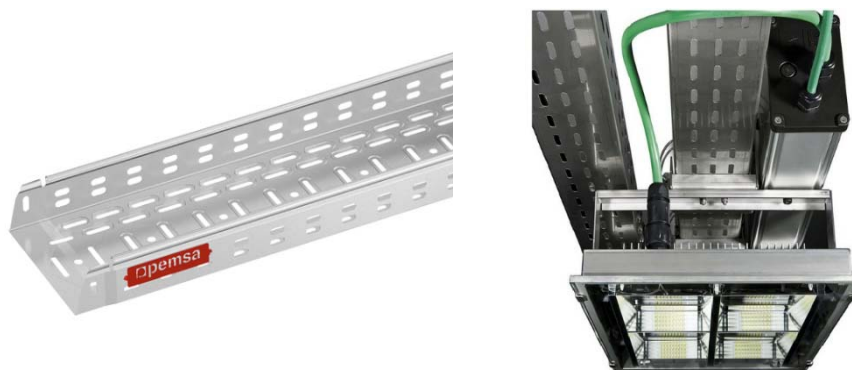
Tipo de bandeja propuesto y detalle de montaje
